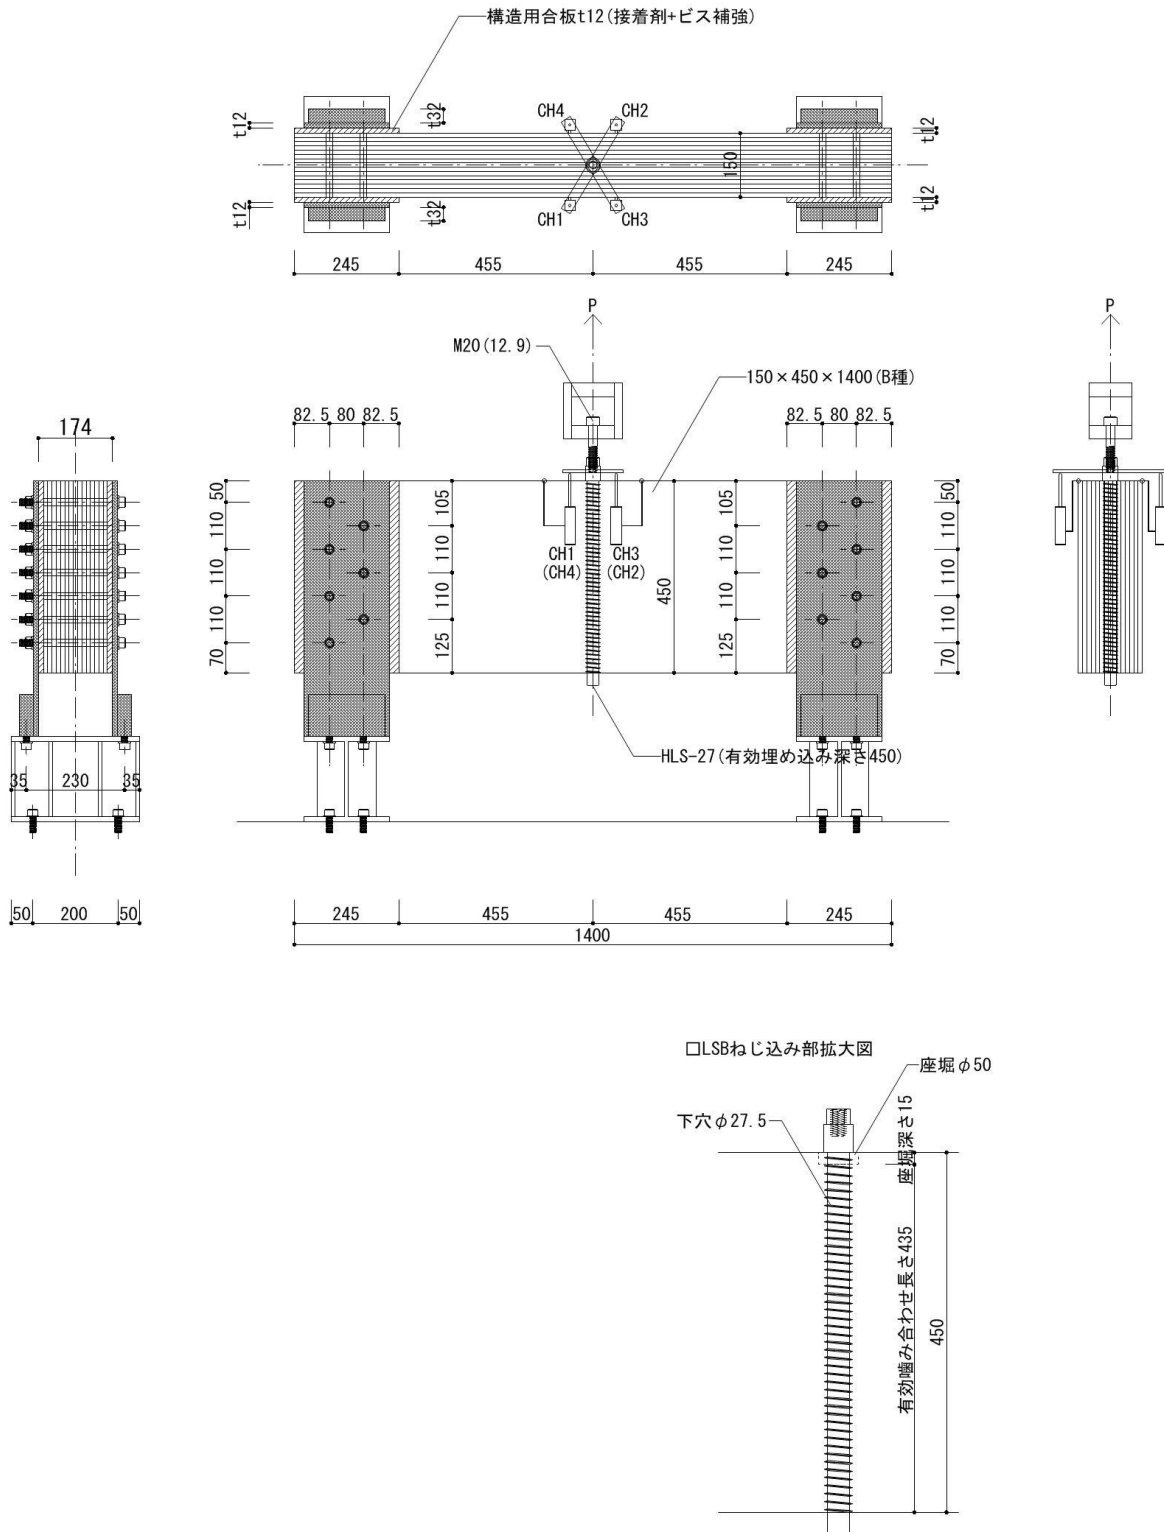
試験体の形状及び寸法 (D-3)
